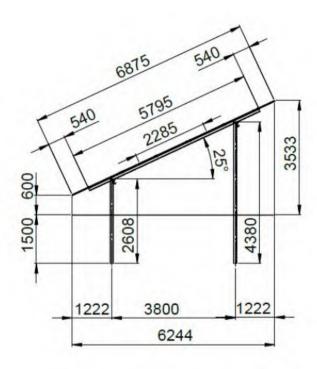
Perfil y dimensiones de la estructura fija tipo Arausol 3Vx24
